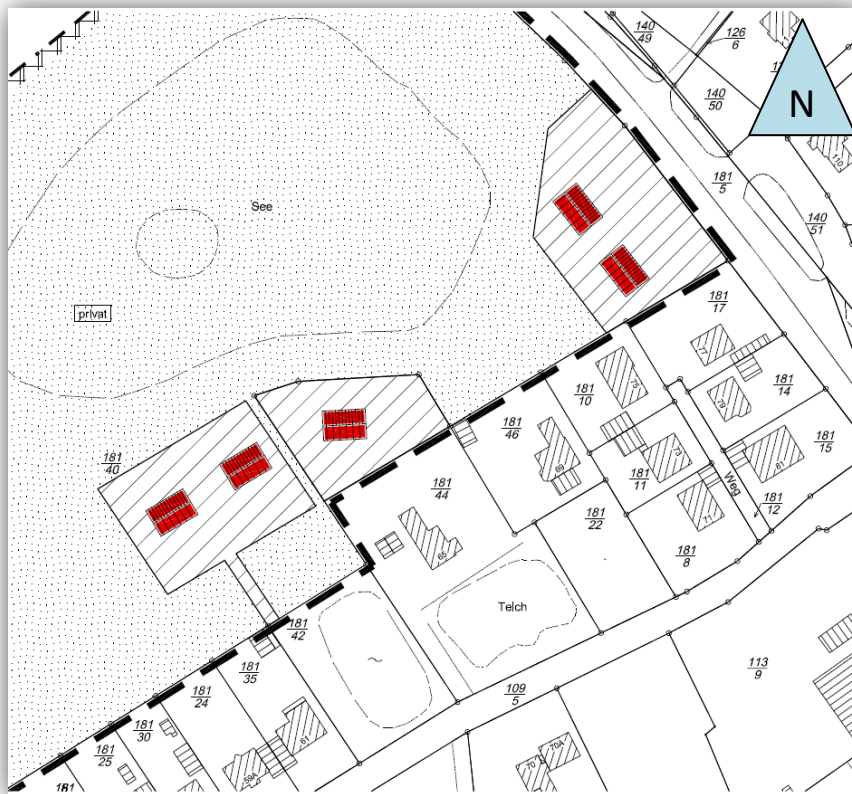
Übersicht über die beiden für eine Wohnbebauung (rot) vorgesehenen Teilflächen. Grundlagenkarte: pk plankontor städtebau.
